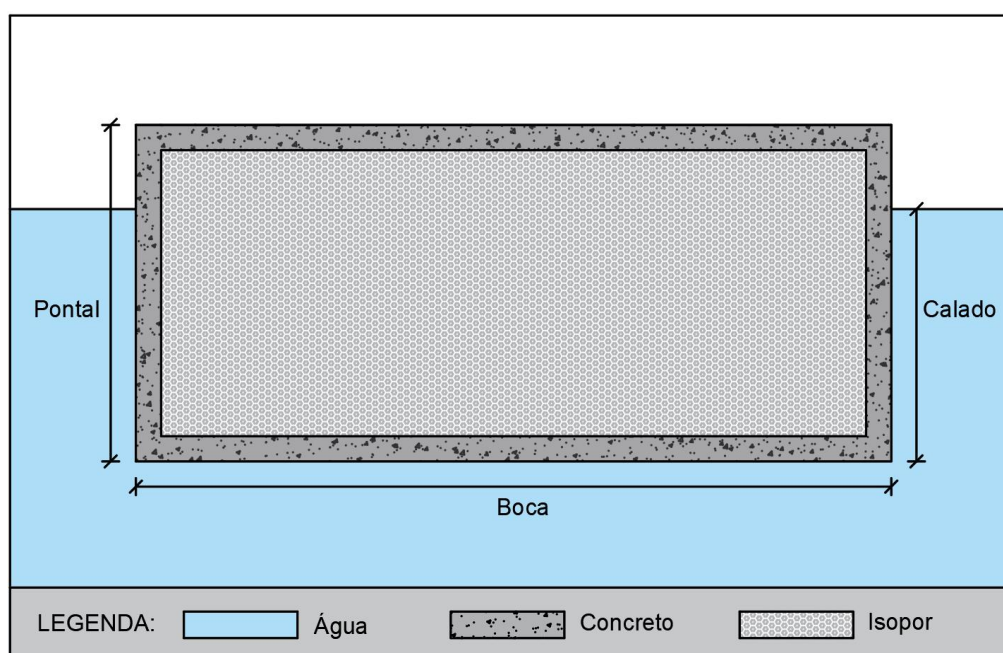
Corte transversal na seção central da viga caixão que forma píer flutuante de concreto.
